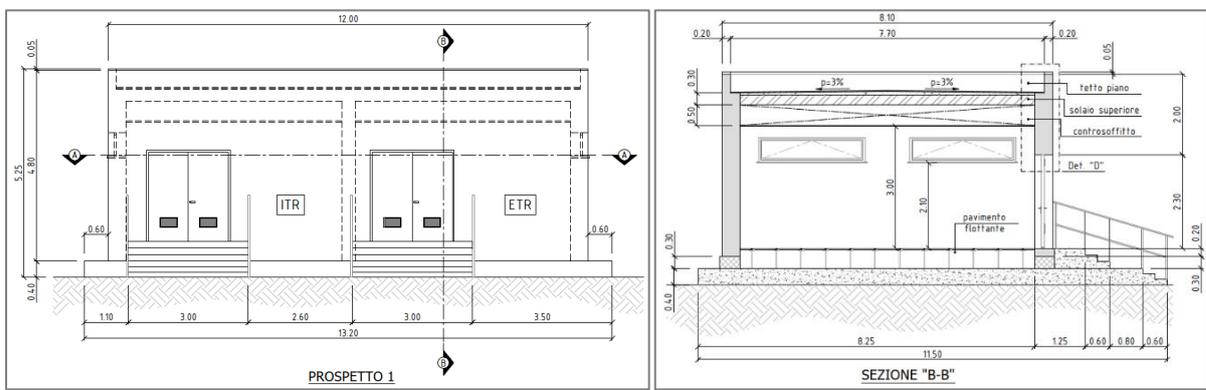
Prospetto frontale locale ITR-ETR poggiato su platea in c.a.
